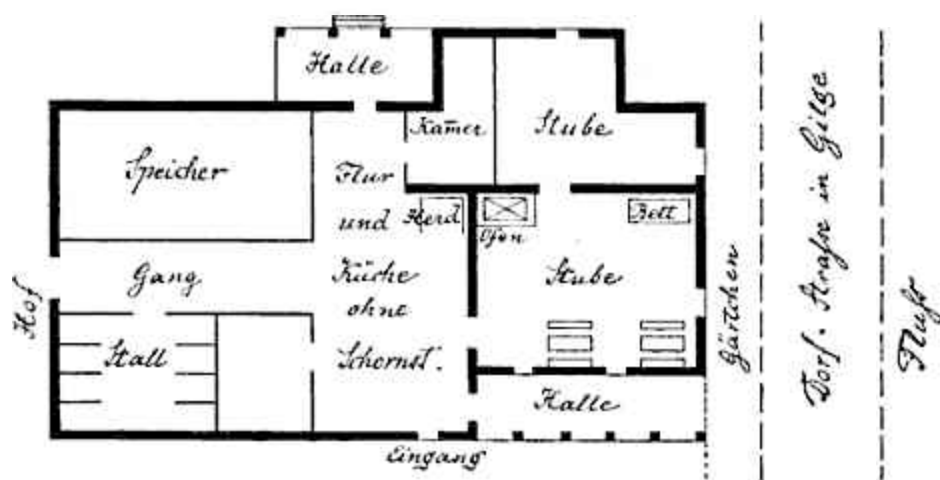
Grundriss eines litauischen Bauernhauses (Gilge).
